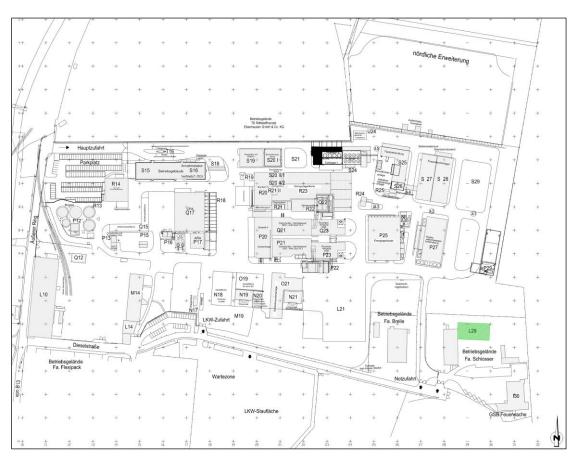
Lageplan der geplanten Stückgutlagerhalle L29 (Quelle: IA-Tech GmbH)
